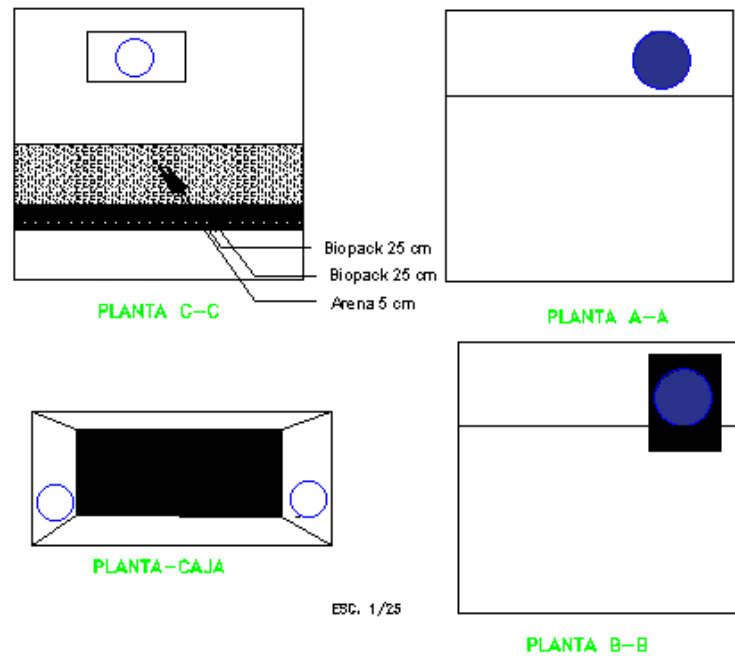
“Dimensionamiento de planta en corte del FAFA ”
